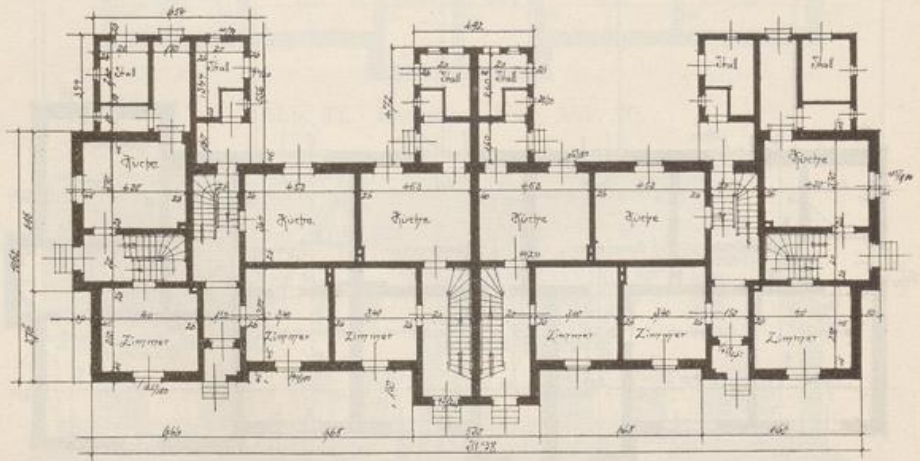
Grundriß zu Abb. 98. Erdgeschoß.
